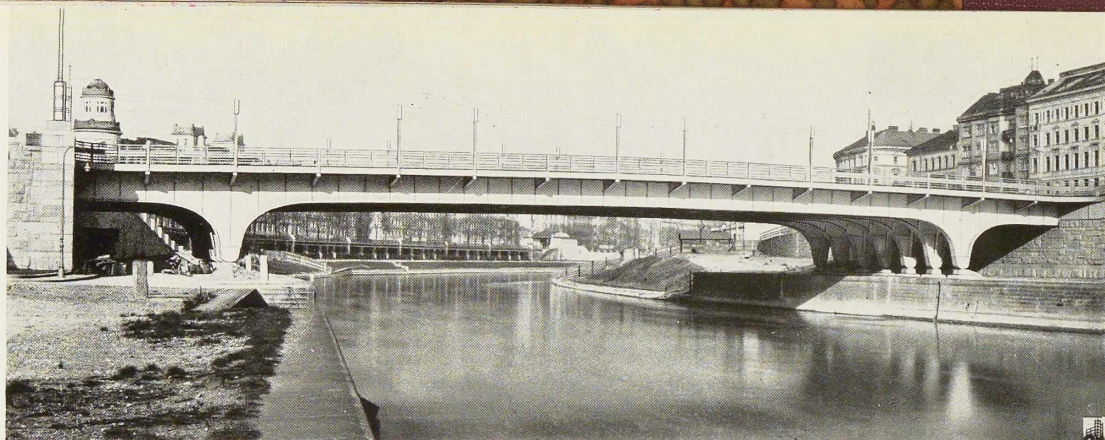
L'Augartenbrücke a été construit en 1929. Il comporte 7 poutres continues à 4 travées.
